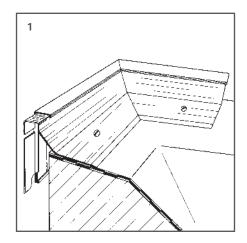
Blendenprofil mit mind. 20 mm Abstand vom Mauerwerk ausrichten und mit korrosionsbeständigen Schrauben befestigen.
